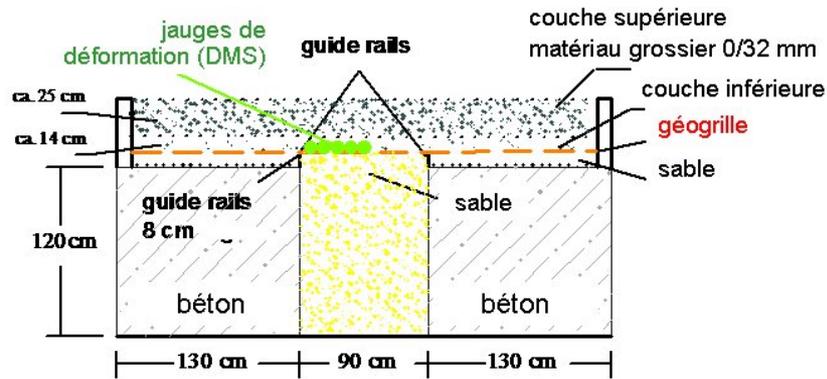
Disposition de la planche d'essai. Le sable au centre de la planche d'essai est excavé après compactage de la couche de matériau supérieur.
